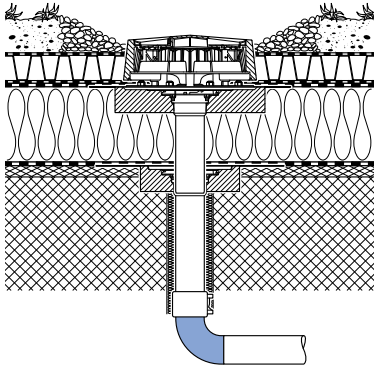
Anschluss des Geberit Pluvia Dachwassereinlaufs mit einem Bogen 90°
